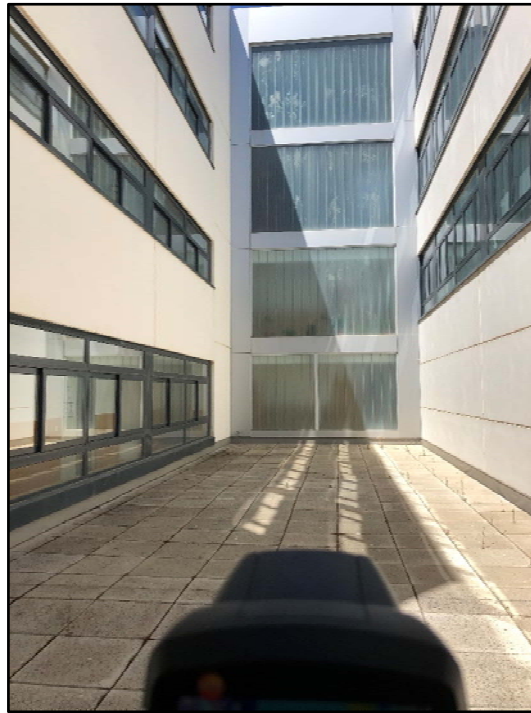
Zona de la envolvente general donde se aprecian los acristalamientos de fachada.
